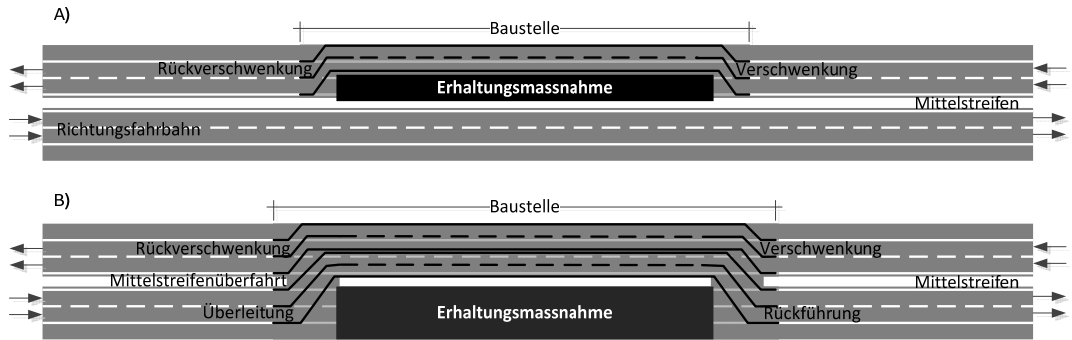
Baustelle A) mit Verschwenkung und Rückverschwenkung, B) mit Überleitung und Rückführung auf einer 2x2-streifigen Autobahn mit durchgehend baulicher Richtungstrennung
